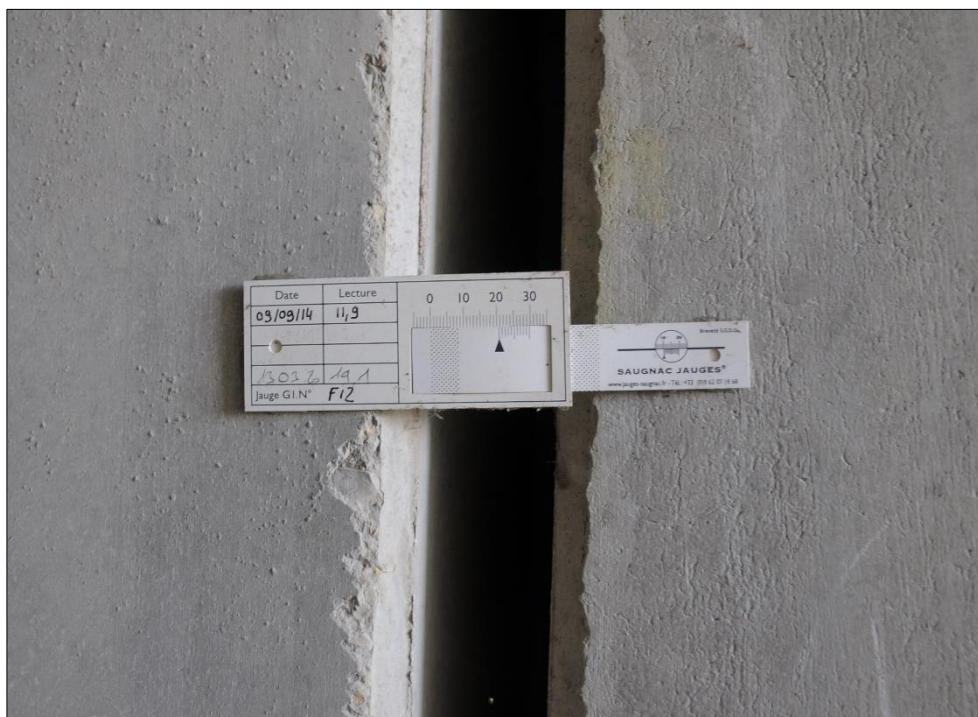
Fissuromètre mis en place à l'interface entre deux voussoirs de l'OH 103
